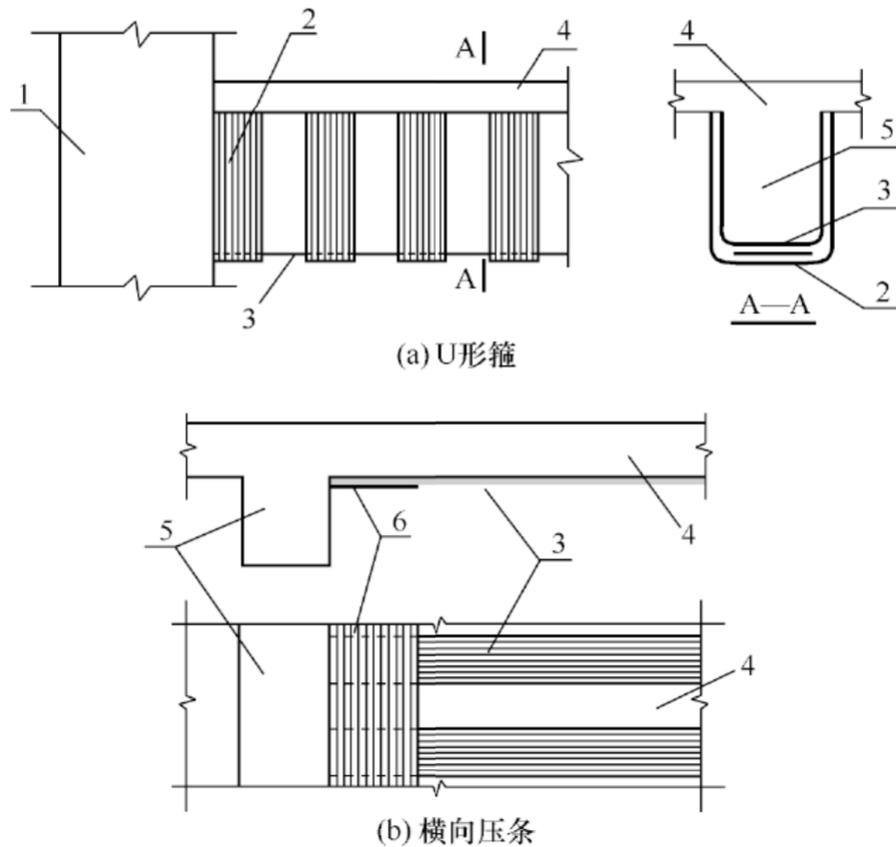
梁、板粘贴纤维复合材端部锚固措施
